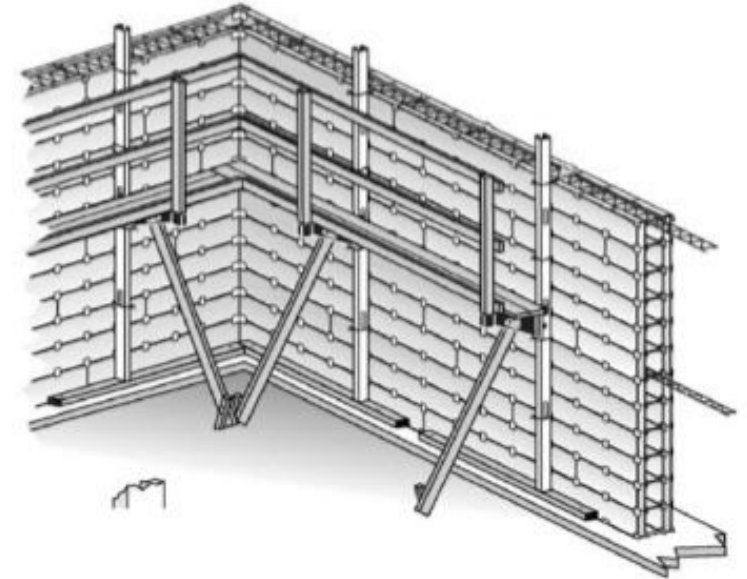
Встановлена опалубки і арматури 1 та 2-го ярусу бетонуванні (додаткові стійки і прогони не показані)
